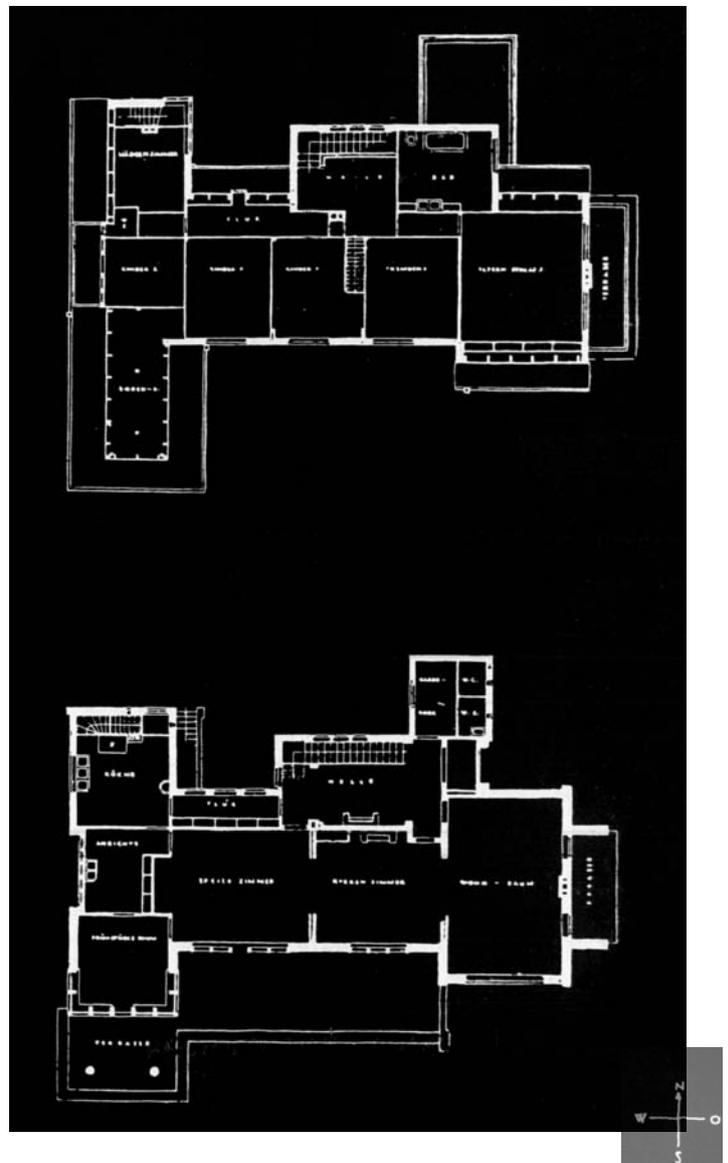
oben: Grundriss Obergeschoss, unten: Erdgeschoss, o.M.
